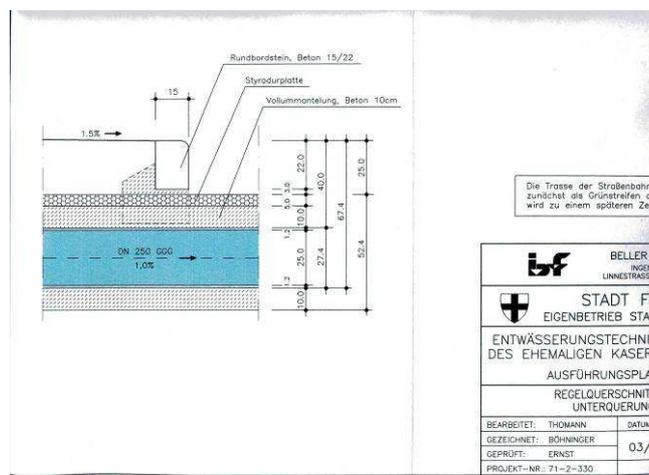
Détail du croisement Route – Bordure et canalisation eau de pluie sous le revêtement.
